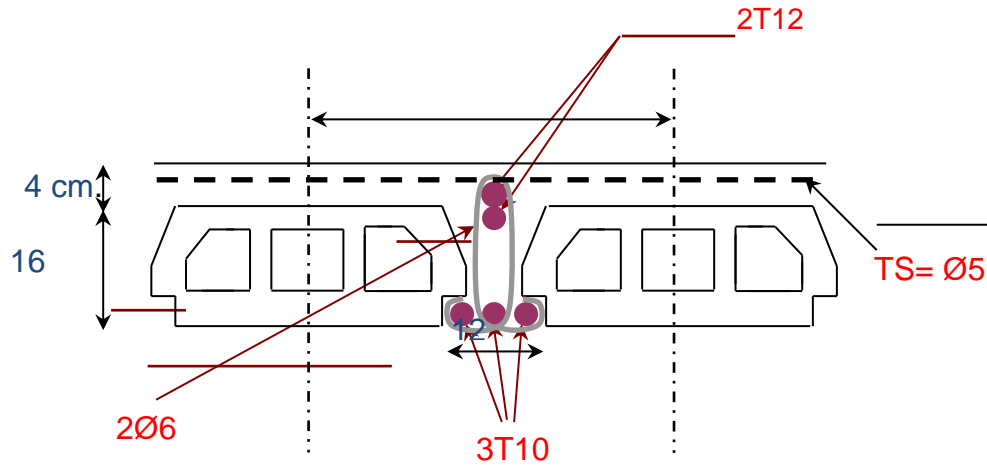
ferrailage des poutrelles au sous-sol et terrasse
